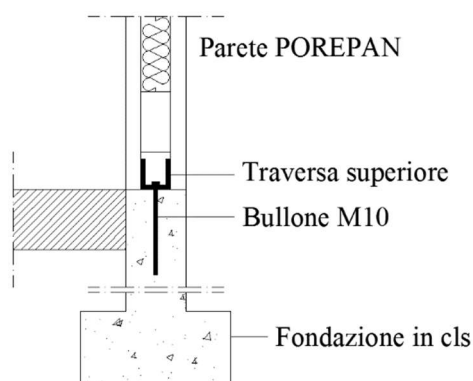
Schema semplificato di collegamento Parete – Fondazione
